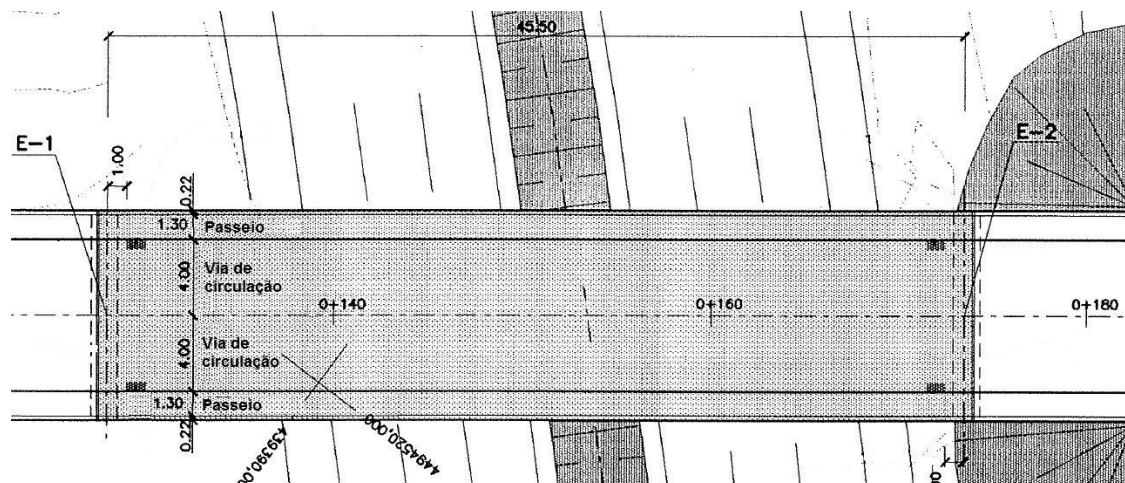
Vista em planta da Ponte Tres Cantos
